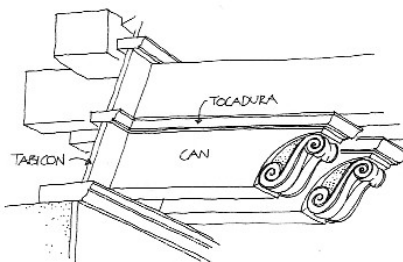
Detalle del apoyo de los tirantes de la armadura en los canes o ménsulas.¹⁵³
